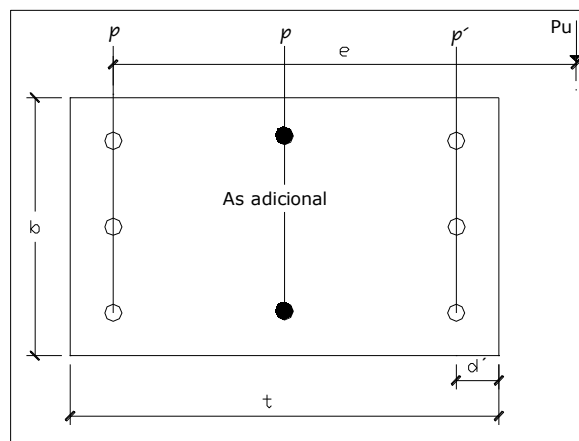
Columnas rectangulares con falla a tracción armadas a cuatro caras.
